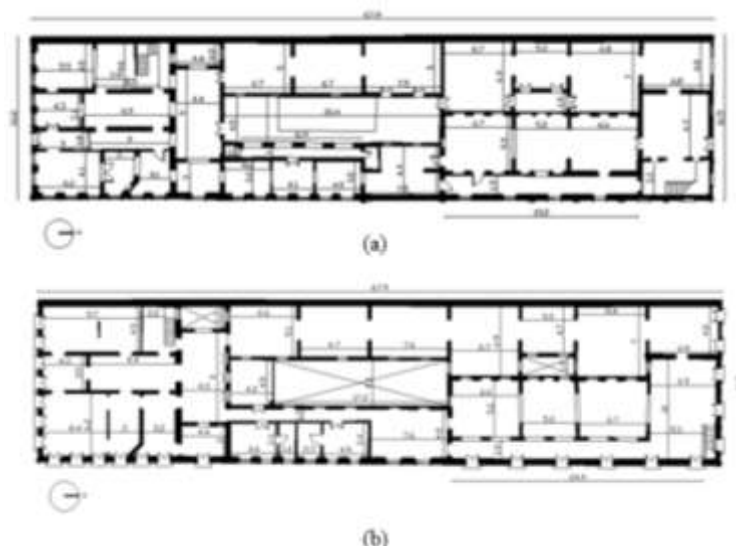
(a) Planta baixa do 1º pavimento e (b) Planta baixa do 2º pavimento do Museu Dom José.
